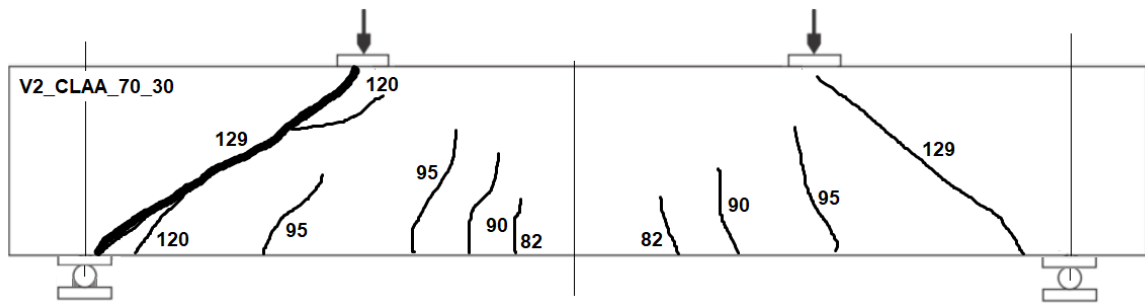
Esquema de fissuração da Viga 2_CLAA_70_30.
